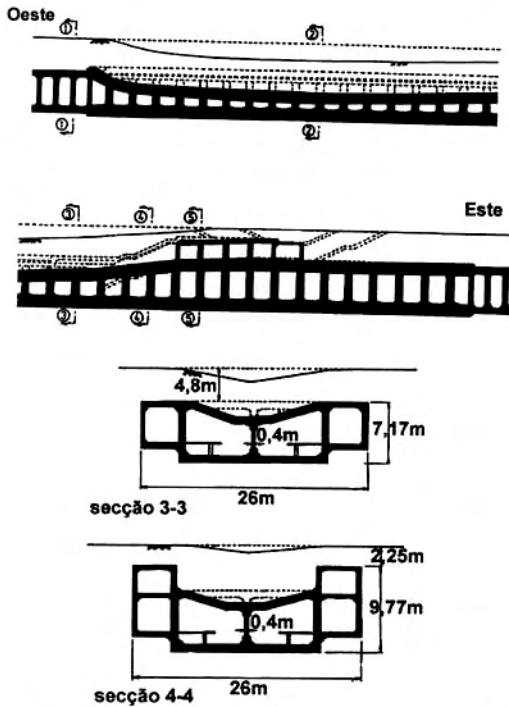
Roturas na estação Daikai em perfis longitudinais e transversais,
